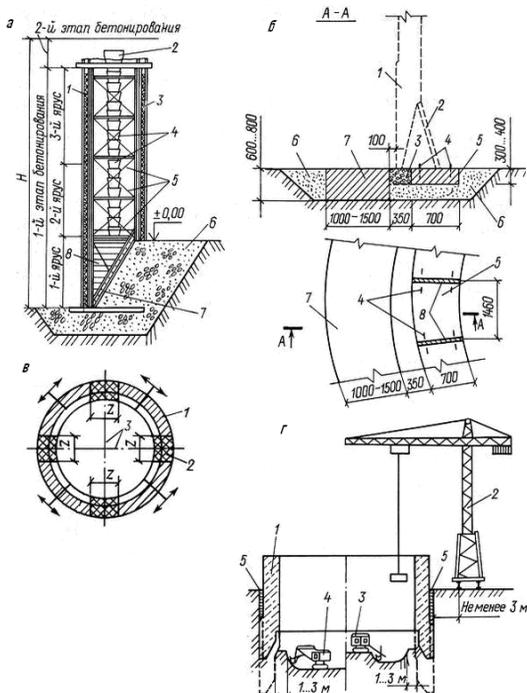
Опускные колодцы: *а* – схема бетонирования стены; 1, 3 – соответственно наружная и внутренняя опалубки стены; 2 – приемная воронка для бетонной смеси; 4 – хобот для подачи бетонной смеси; 5 – армокаркас; 6 – щебень; 7 – опалубка; *б* – устройство основания под нож стен, выполненных из сборных панелей: 1 – нож; 2 – опорные стойки; 3 – уплотненный щебень; 4 – монтажные петли; 5 – опорное кольцо из сборных железобетонных блоков; 6 – обратная песчаная засыпка; 7 – форшахта из бетона; 8 – разделительные доски; *в* – схема расположения фиксированных зон: 1 – колодец; 2 – фиксированные зоны; 3 – оси фиксированных зон; *г* – схема разработки грунта в колодце насухо: 1 – колодец; 2 – башенный кран; 3, 4 – экскаваторы; 5 – тиксотропная рубашка
